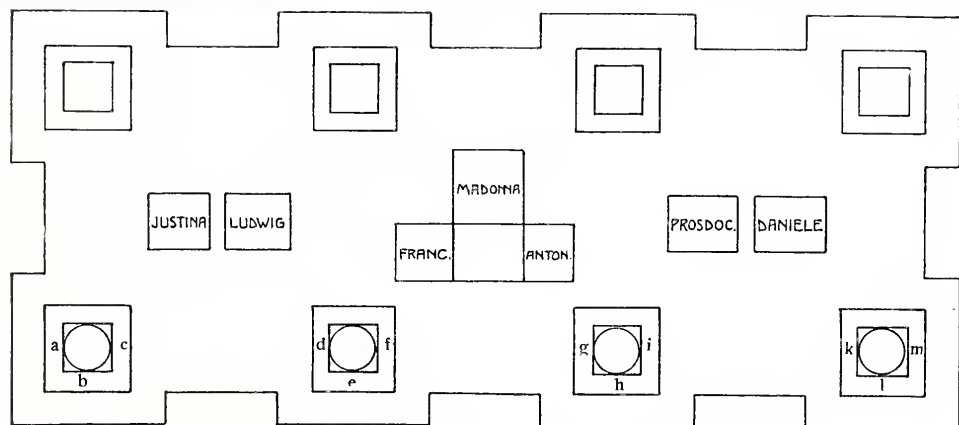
Rekonstruierter Grundriß des Hochaltars
